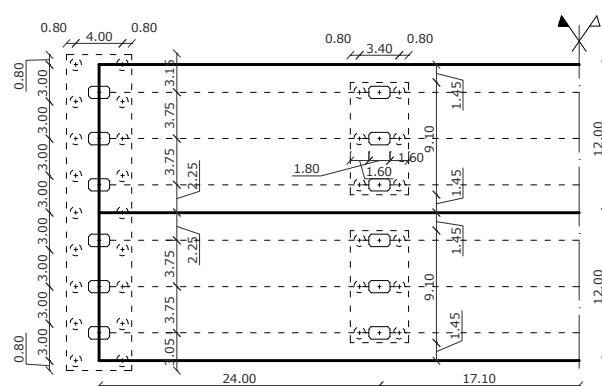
Pianta delle fondazioni e degli impalcati del ponte.
